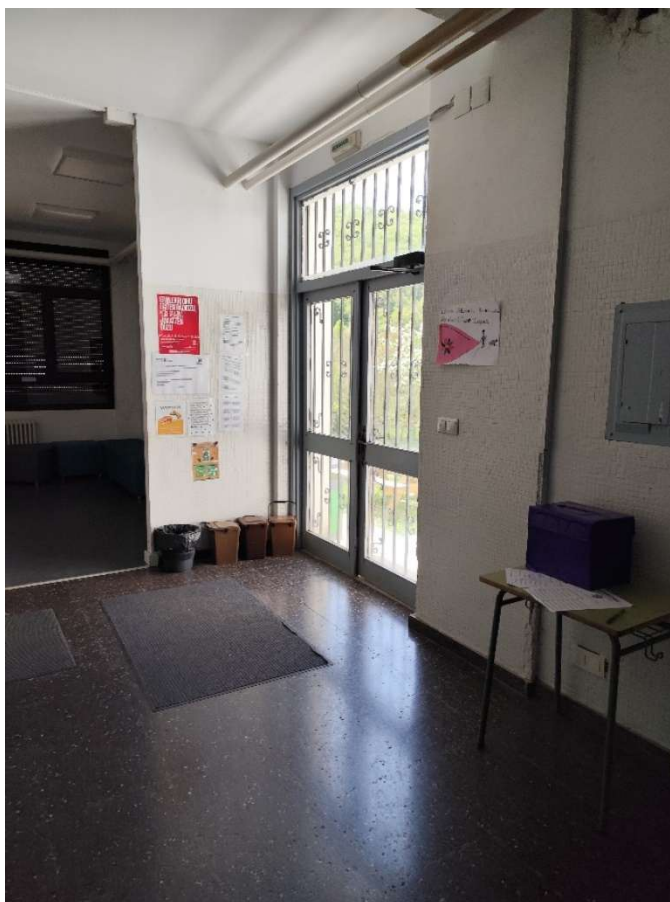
Detalle Carpinterías Actuales en aluminio.
